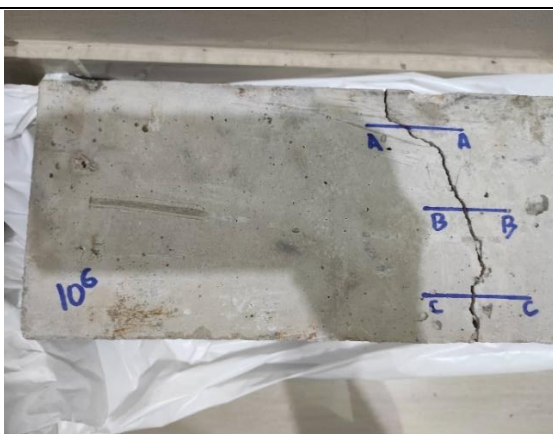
Viga de bioconcreto 1×10^6 cel/ml fisurada, antes.
